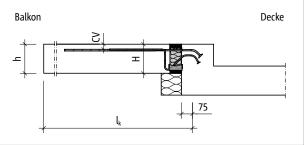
Schöck Isokorb® T Typ KL-O: Statisches System
